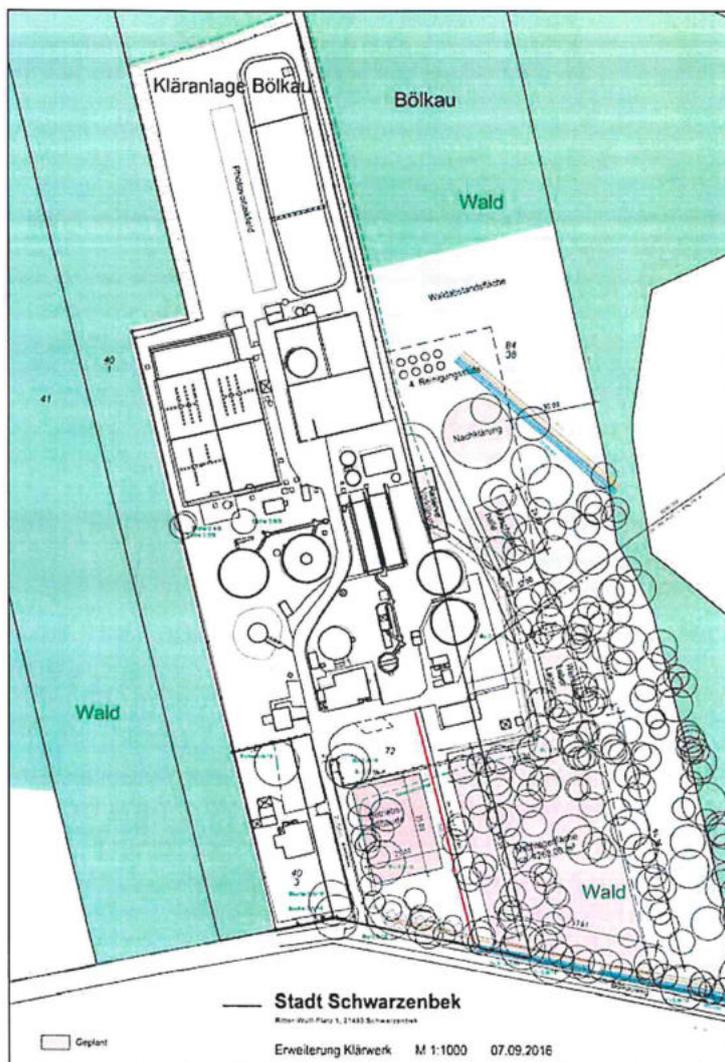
Ursprünglich vorgesehenes Konzept zur Erweiterung des Klärwerkes mit Nachlagerungsflächen für den Klärschlamm innerhalb von Waldflächen
